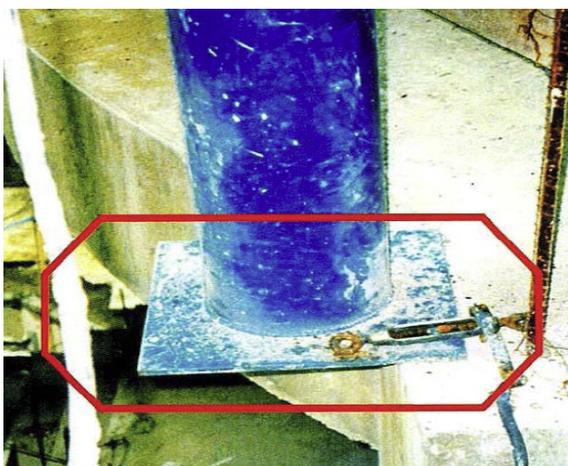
Incompatibilidade entre o projeto da estrutura metálica e da estrutura de concreto. (CASTRO,1999)
